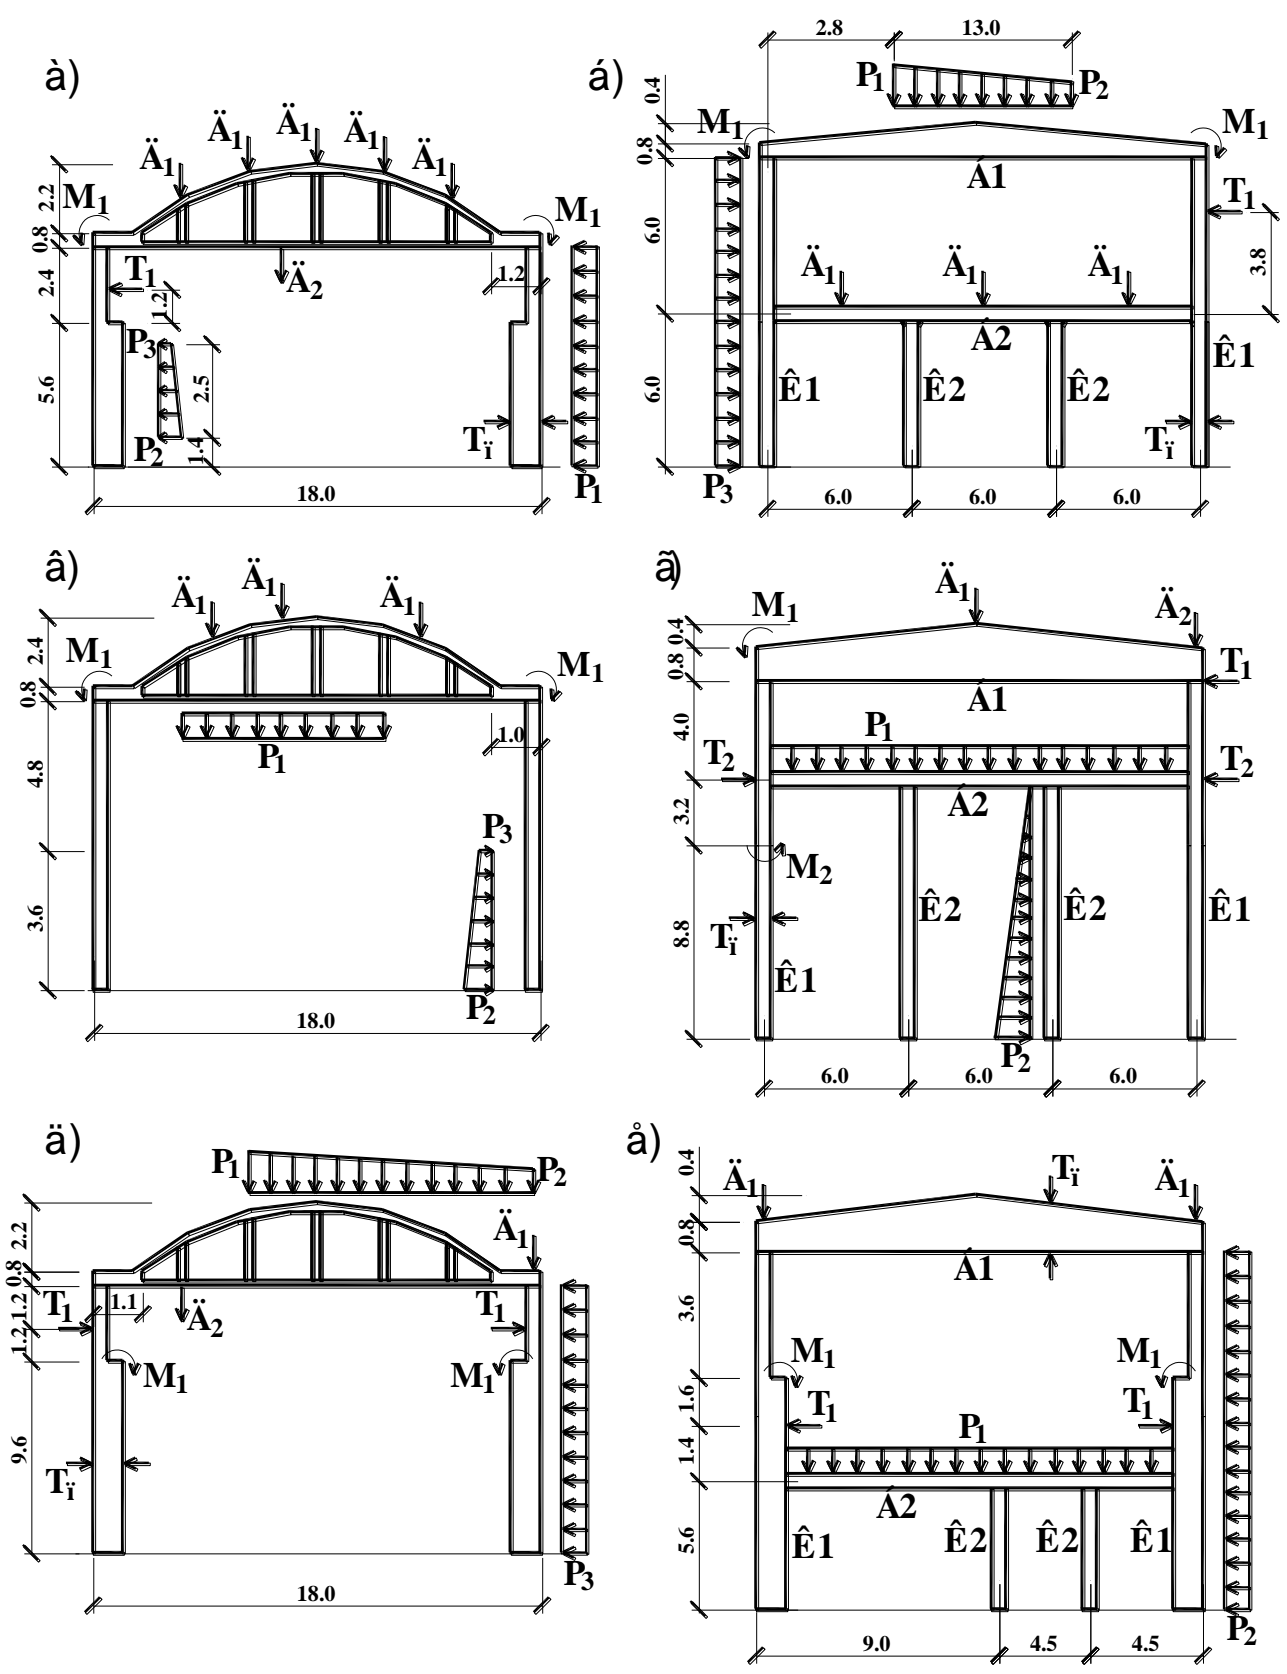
Розрахункові схеми залізобетонних рам.
